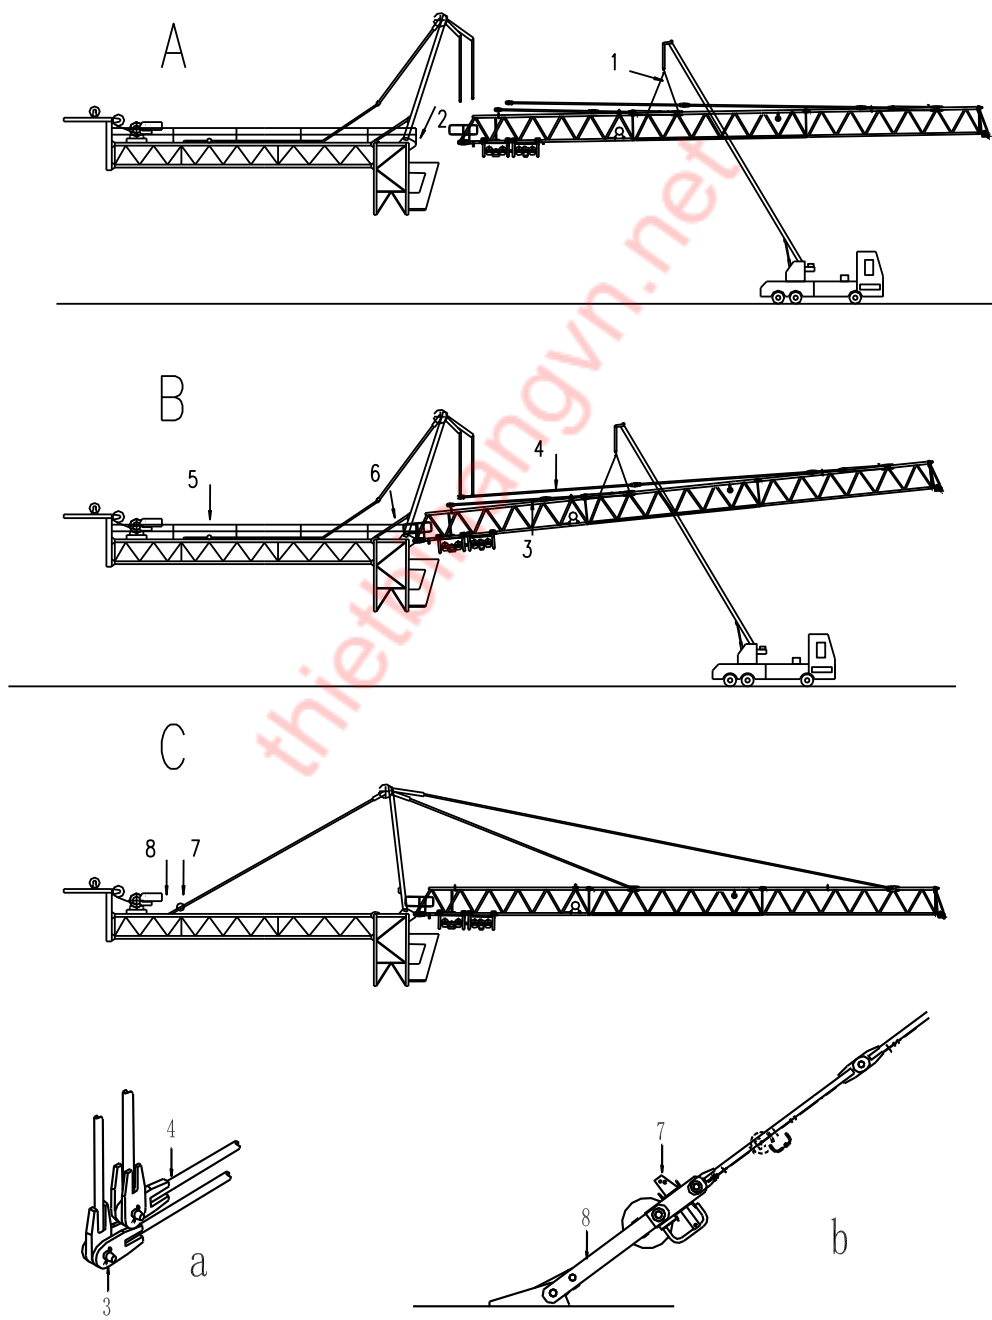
安装起重臂 Fig. 4-38 Fitting the jib
